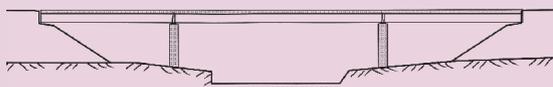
Ouvrage avec tablier de hauteur constante sur toute sa longueur
